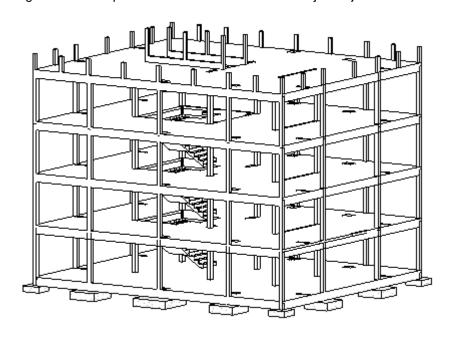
Perspectiva 3D da estrutura da edificação objeto de estudo
